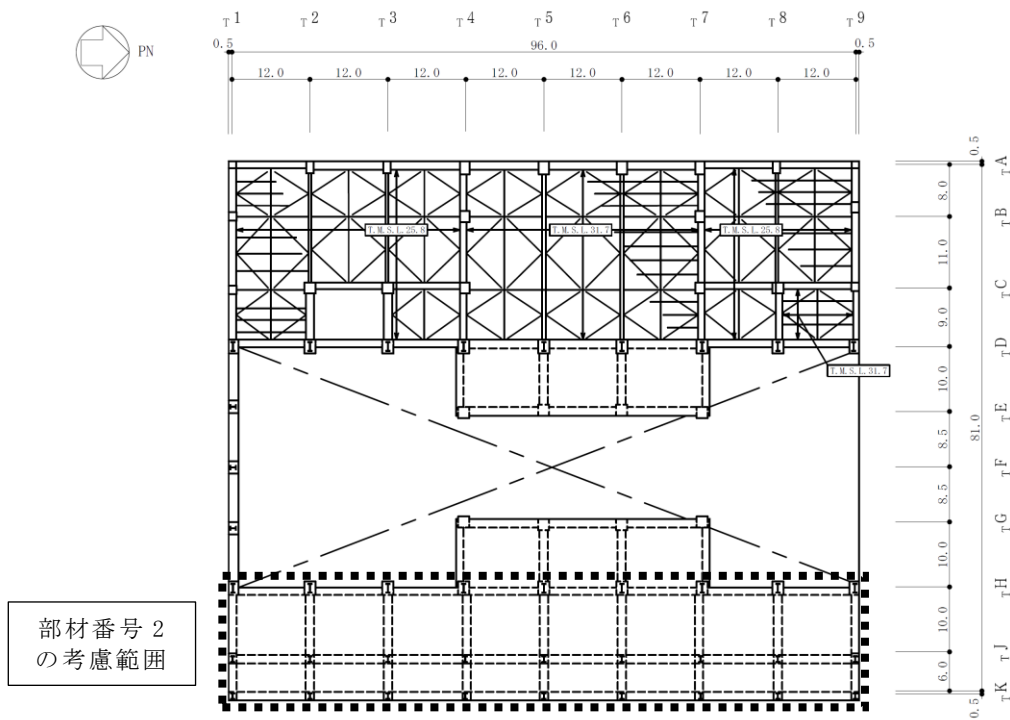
7号機タービン建屋の概略平面図 (T.M.S.L. 30.9m) (単位 : m)
